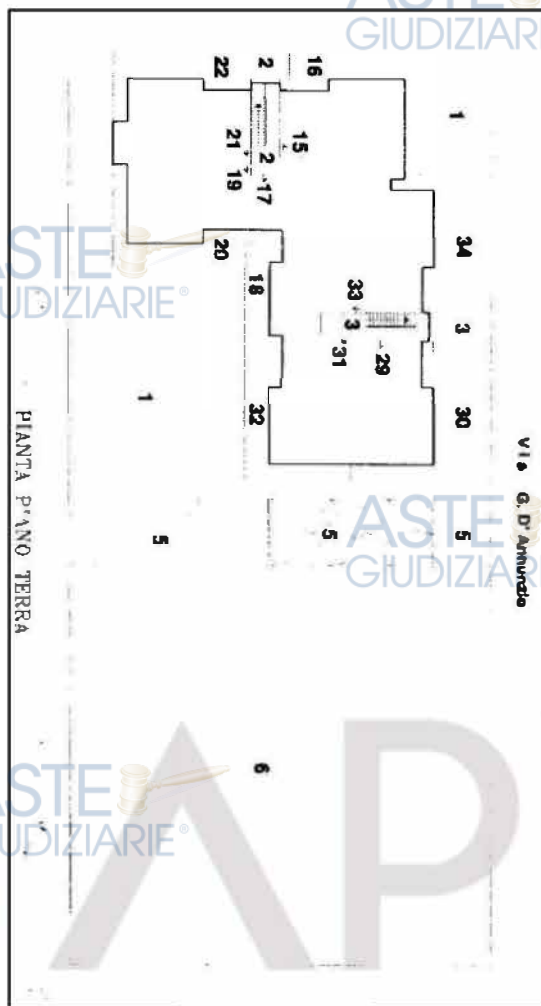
Estratto dell'elaborato planimetrico alla data della compravendita
